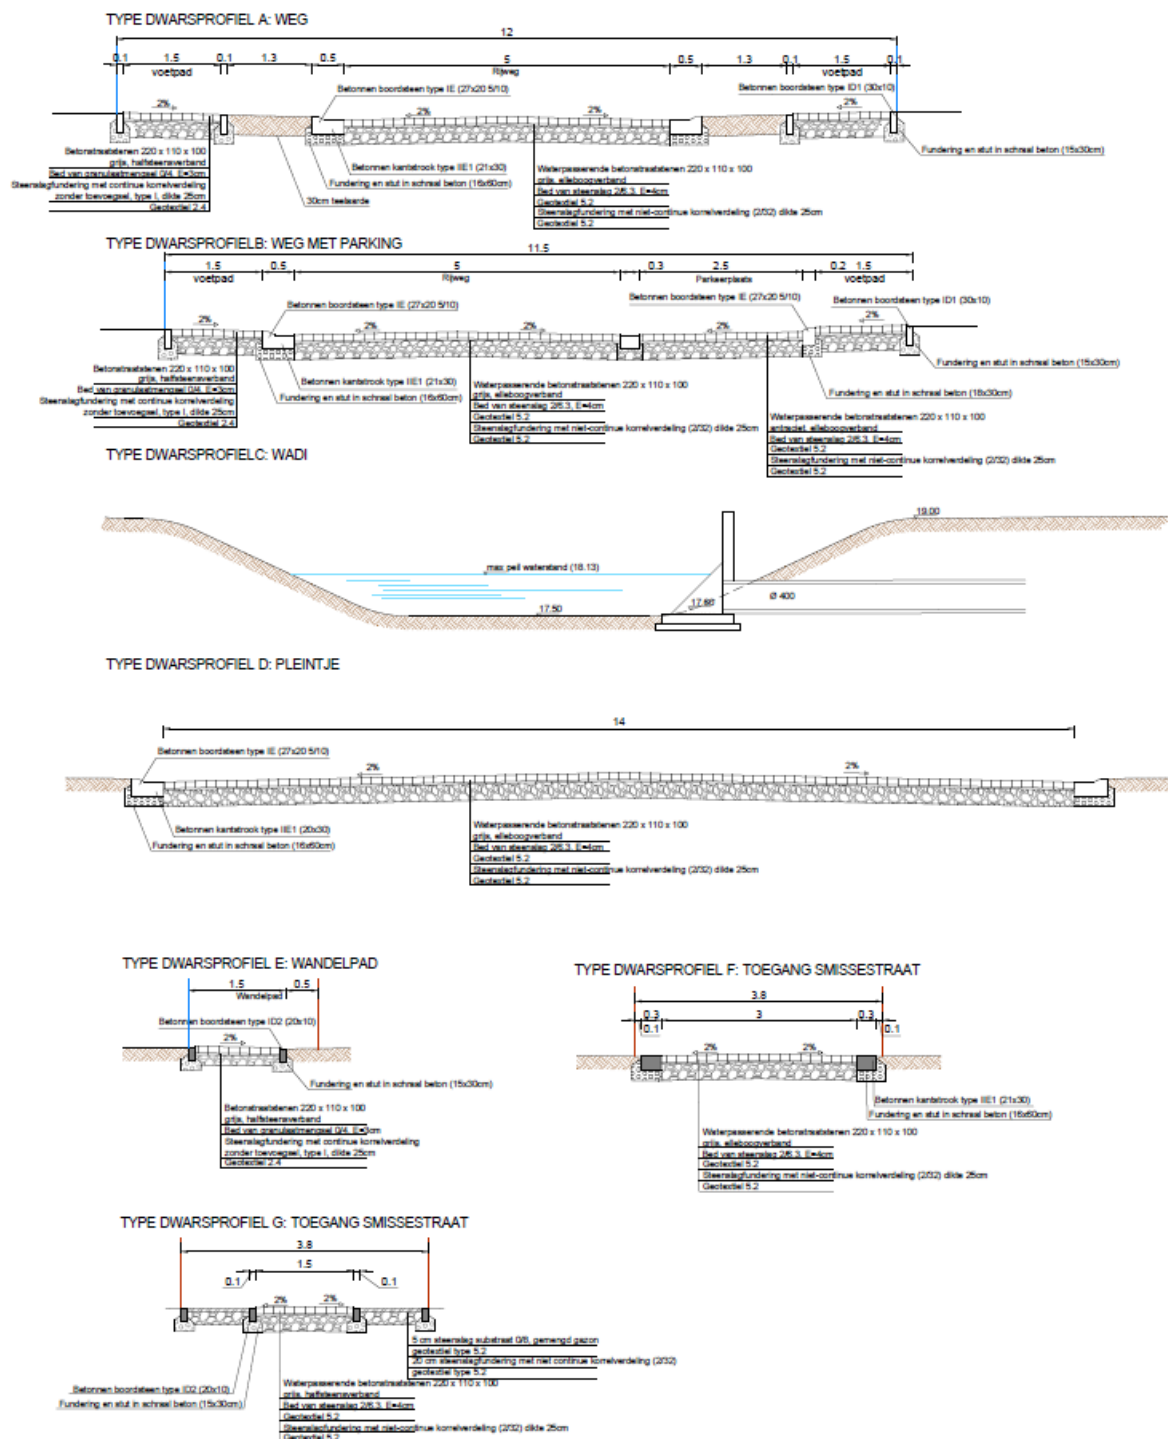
zijn de dwarsprofielen te zien. De wegenis zal bestaan uit waterpasserende betonstraatstenen van 10 cm hoog, gefundeerd op een bed van steenslag (2/6,3), 4 cm dikke laag, 25 cm steenslagfundering met niet-continue korrelverdeling (2/32) en helemaal onderaan geotextiel. De boorden van de weg zullen bestaan uit een betonnen boordsteen en kantstrook, tevens gefundeerd en gestut in schraal beton. De boordstroken en wegenis zullen dus een bodemimpact omvatten van ca. 38 – 40 cm. Ter hoogte van loten 2-3, loten 11-17 en loten 14-15 worden pleintjes geïntegreerd die het mogelijk maken voor de auto's om te keren. Dit is noodzakelijk aangezien de verkaveling doodlopend is aan beide uiteinden. De doorsnede van de pleintjes is gelijkaardig aan die van de
